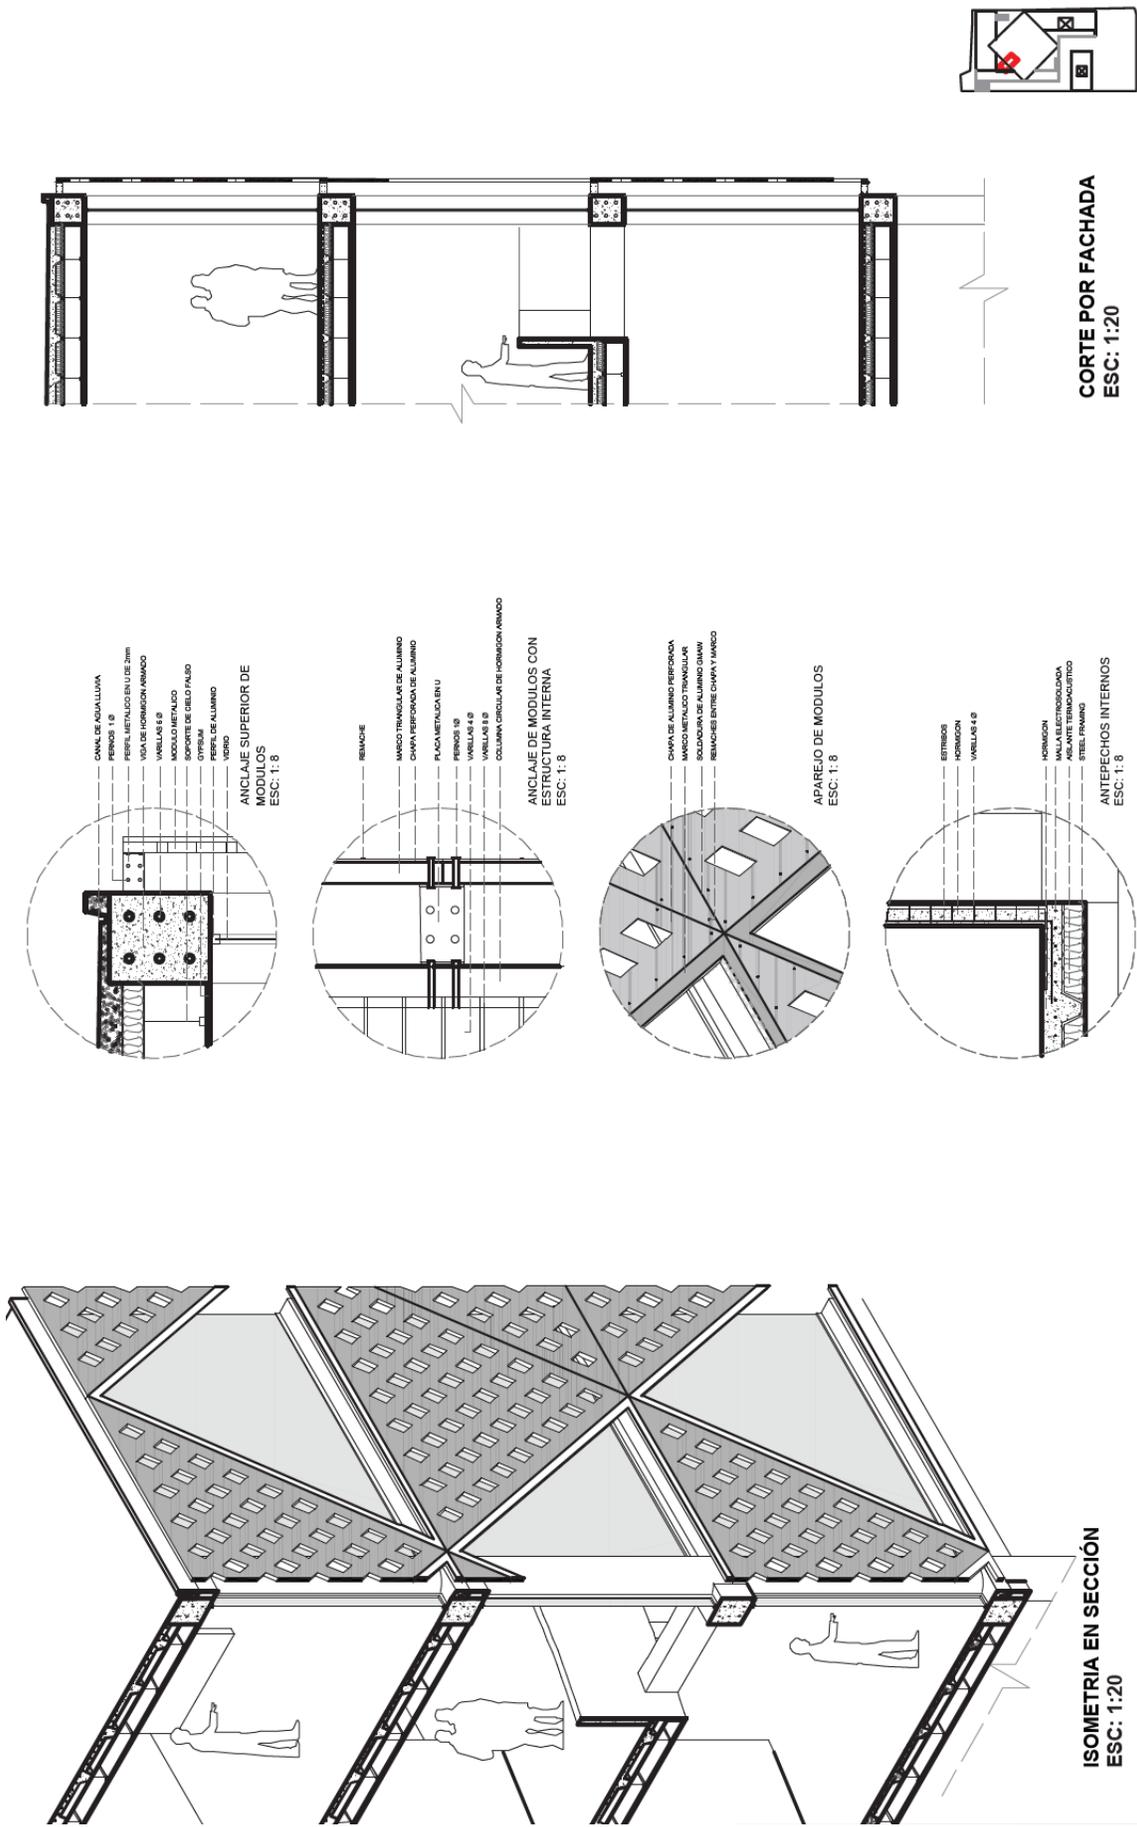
Corte Isométrico y detalles fachada de metal. Elaboración propia.
